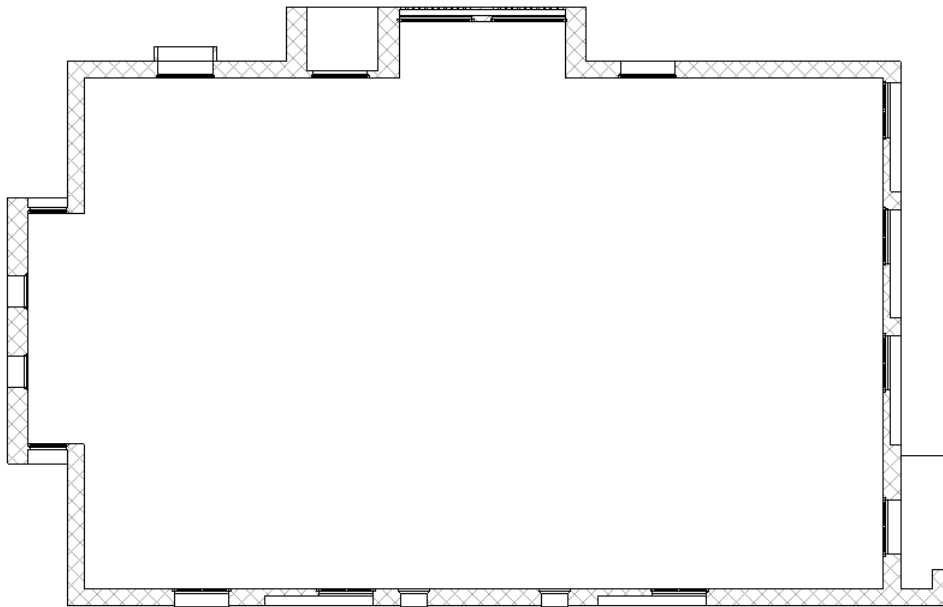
Plan du dernier étage enveloppe en pierre (source : auteur)
